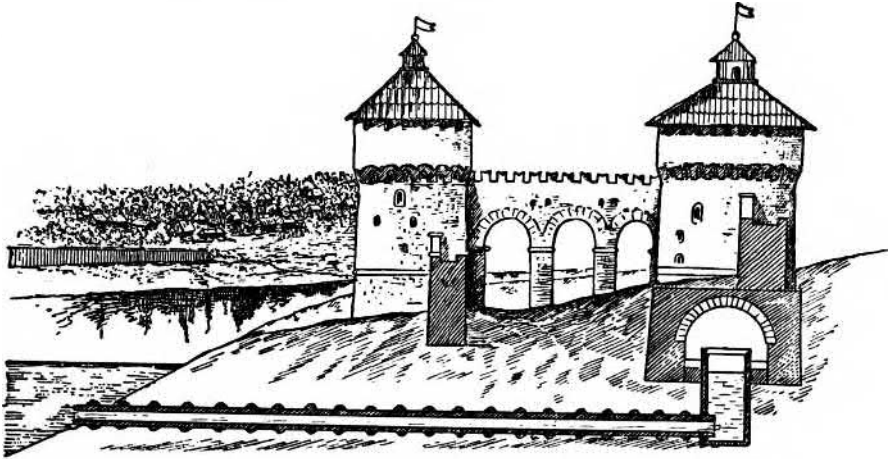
Схема водоснабжения Тайницкой башни (реконструкция).
